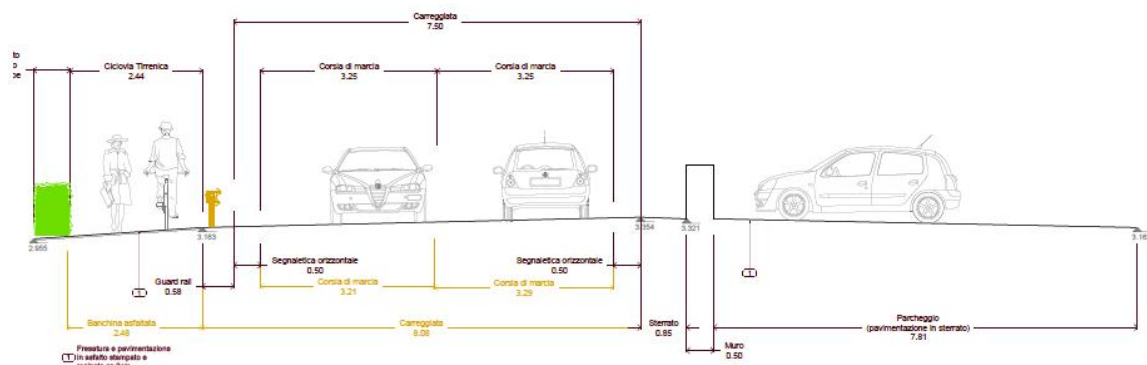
Sezione 23 di progetto trasversale SP delle Collacchie
